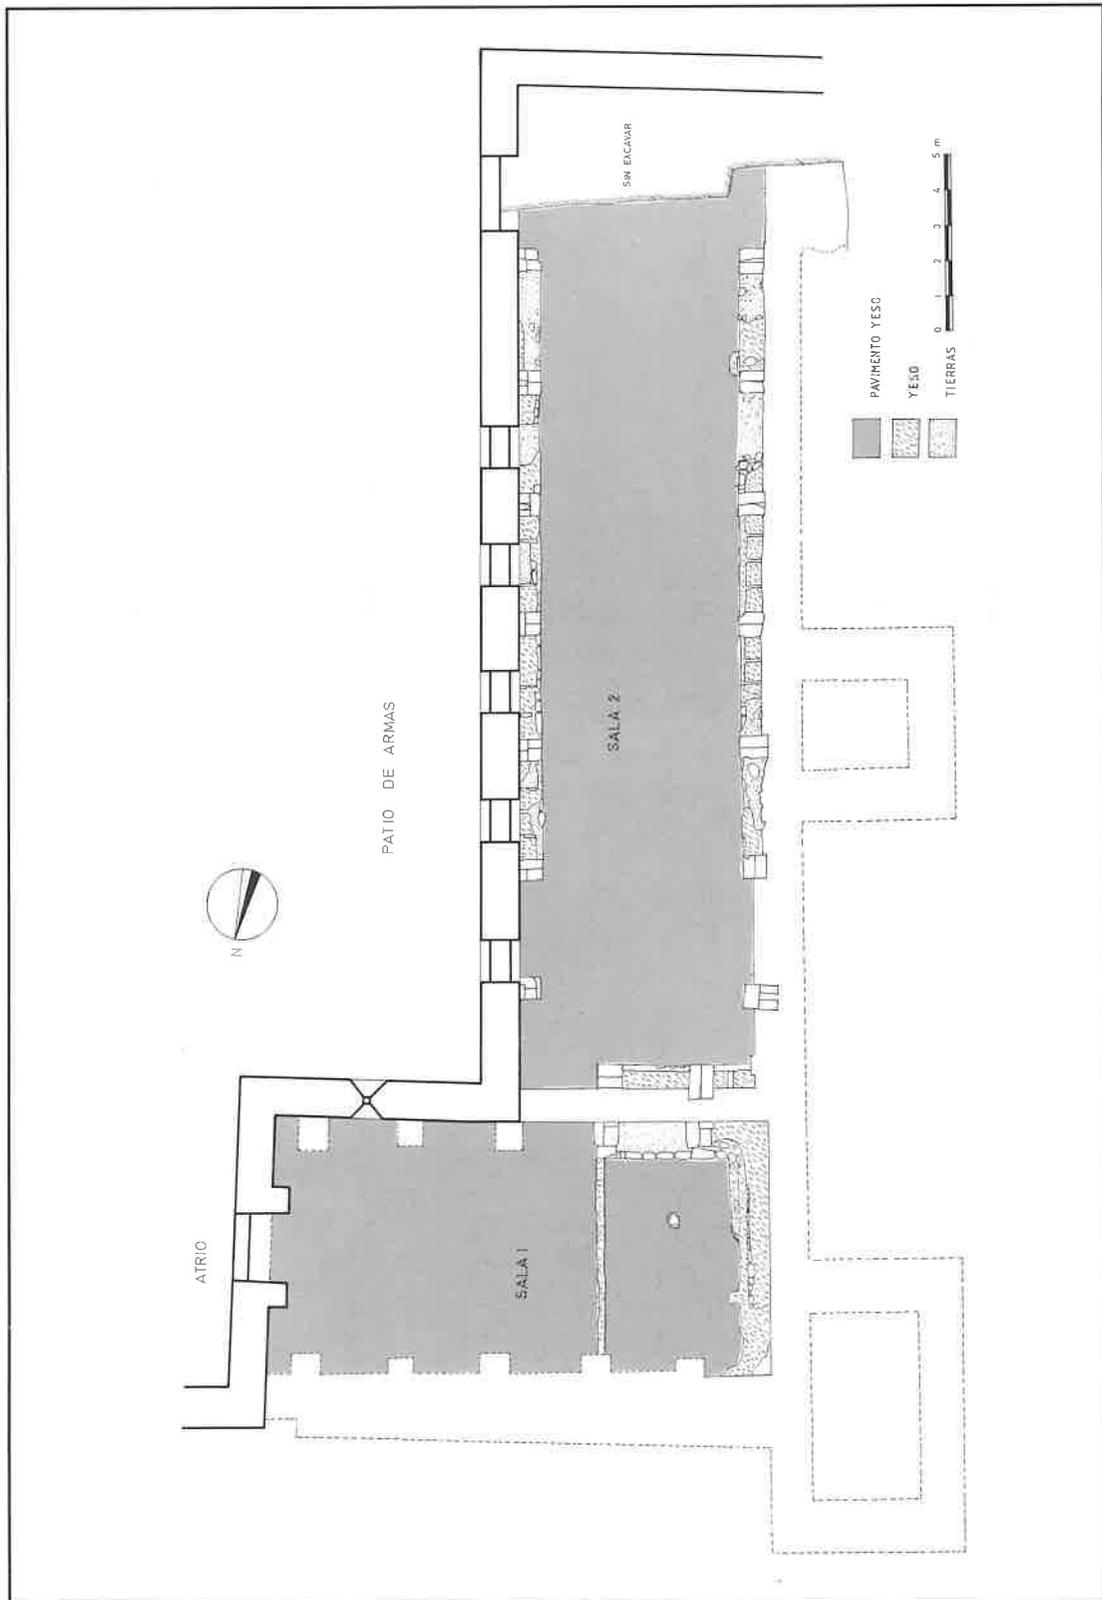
Plano general de pavimentos y estructuras de yeso (pesebres y bancos corridos) de la fase III.
